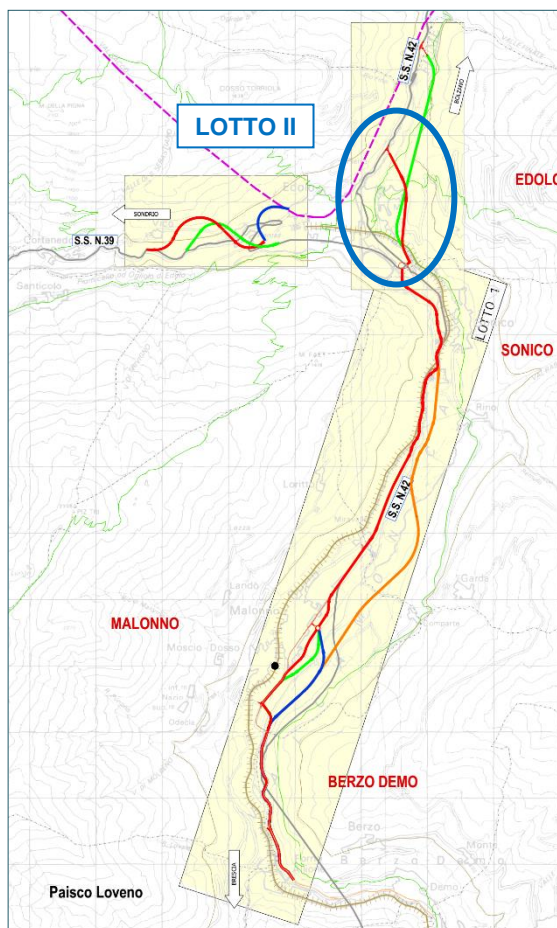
Schema planimetrico tracciati analizzati con il Progetto Preliminare
